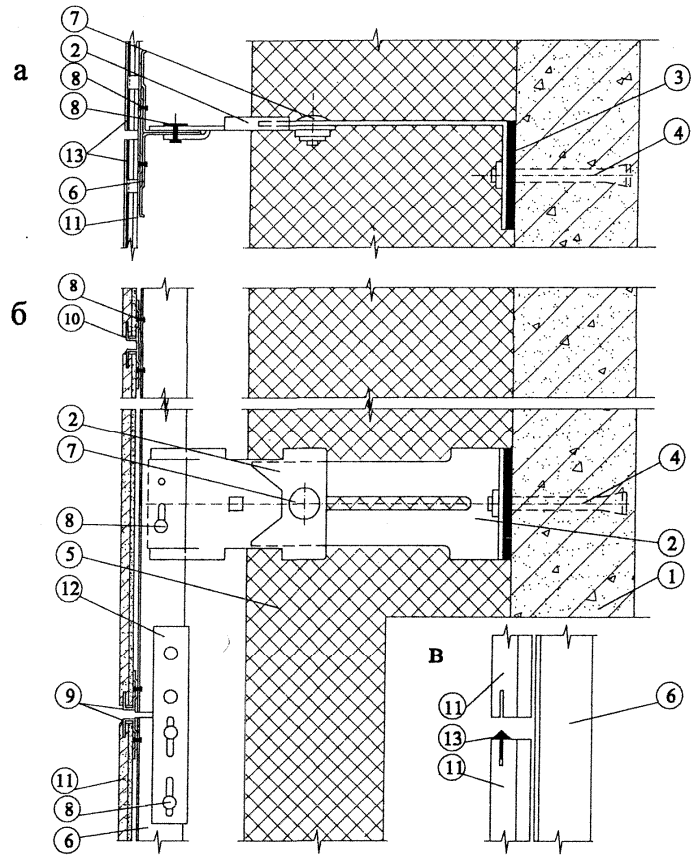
Разрез фасадной системы с облицовкой плитами «Краспан Гранит»
